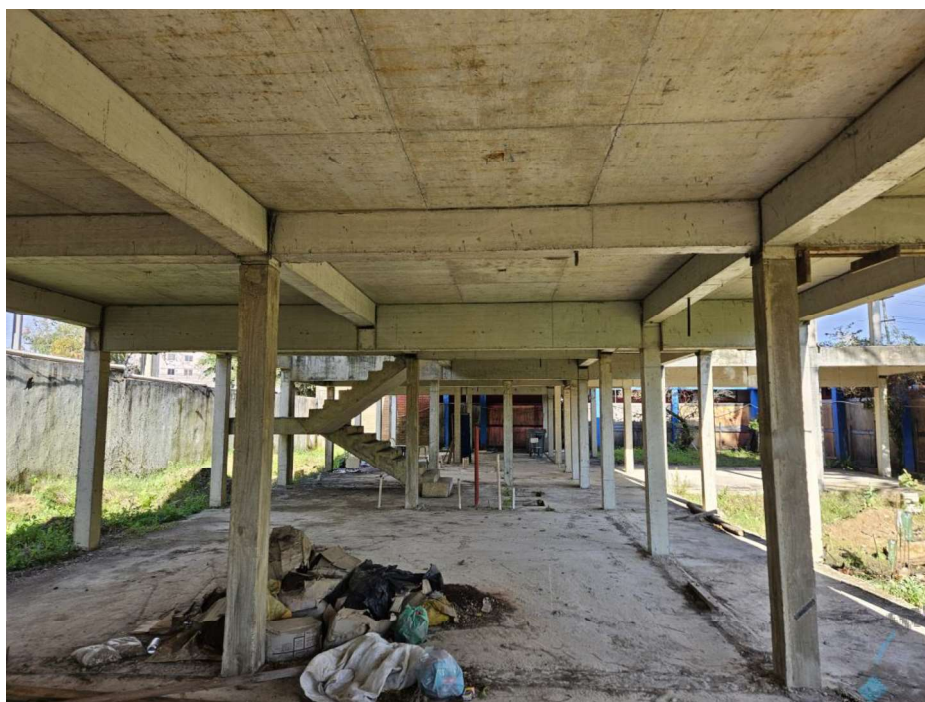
Pavimento Térreo – Edificação Estrutural Existente
